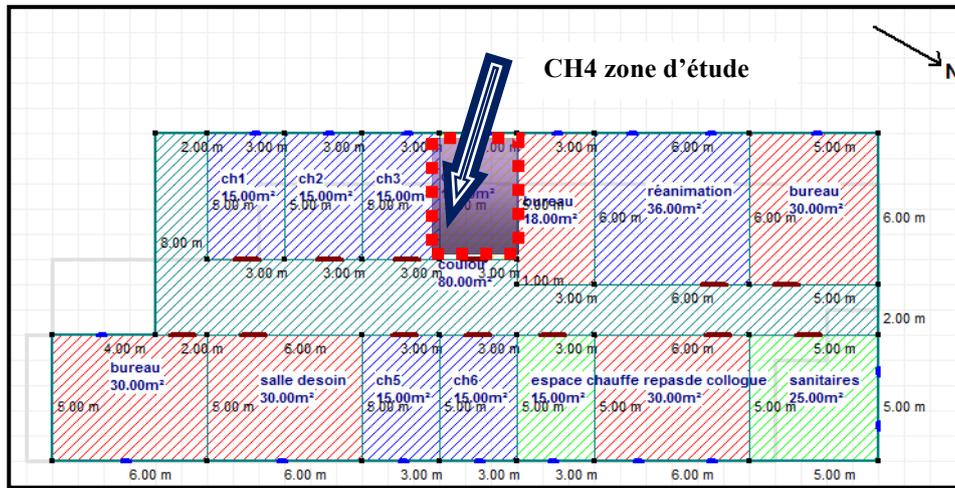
plan de 1^{er} étage alcyone(Source : Auteur)
